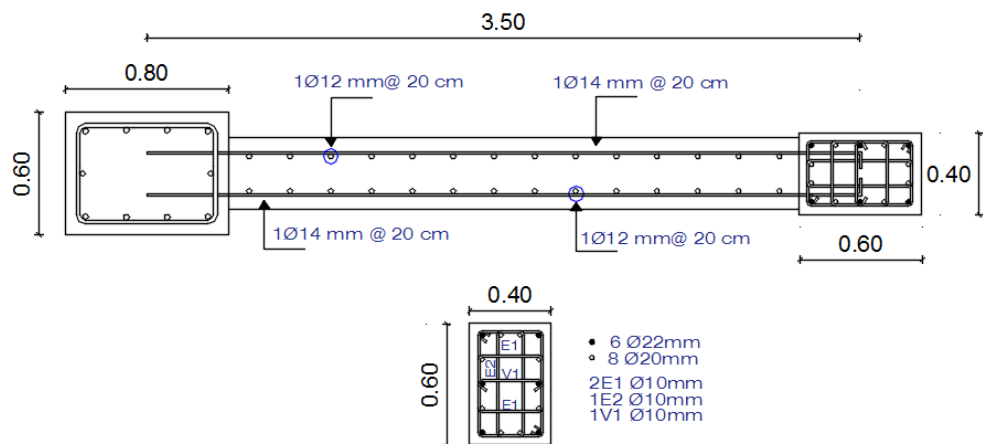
Distribución de acero de refuerzo en cabezal y muro
